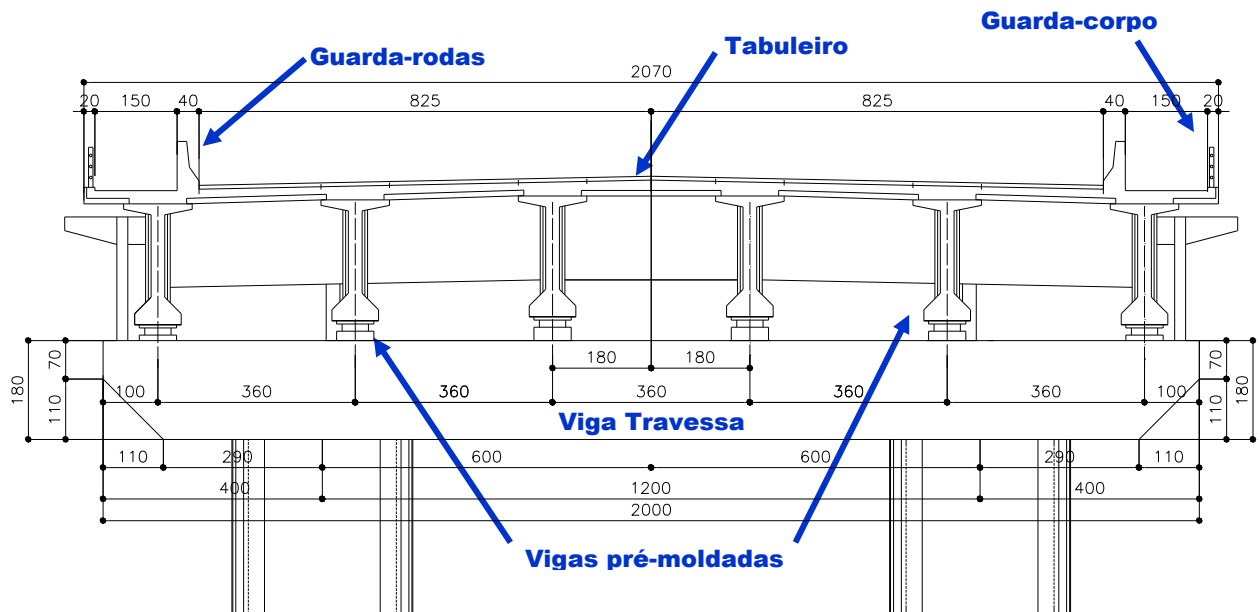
Seção Transversal do trecho corrente da Ponte.
